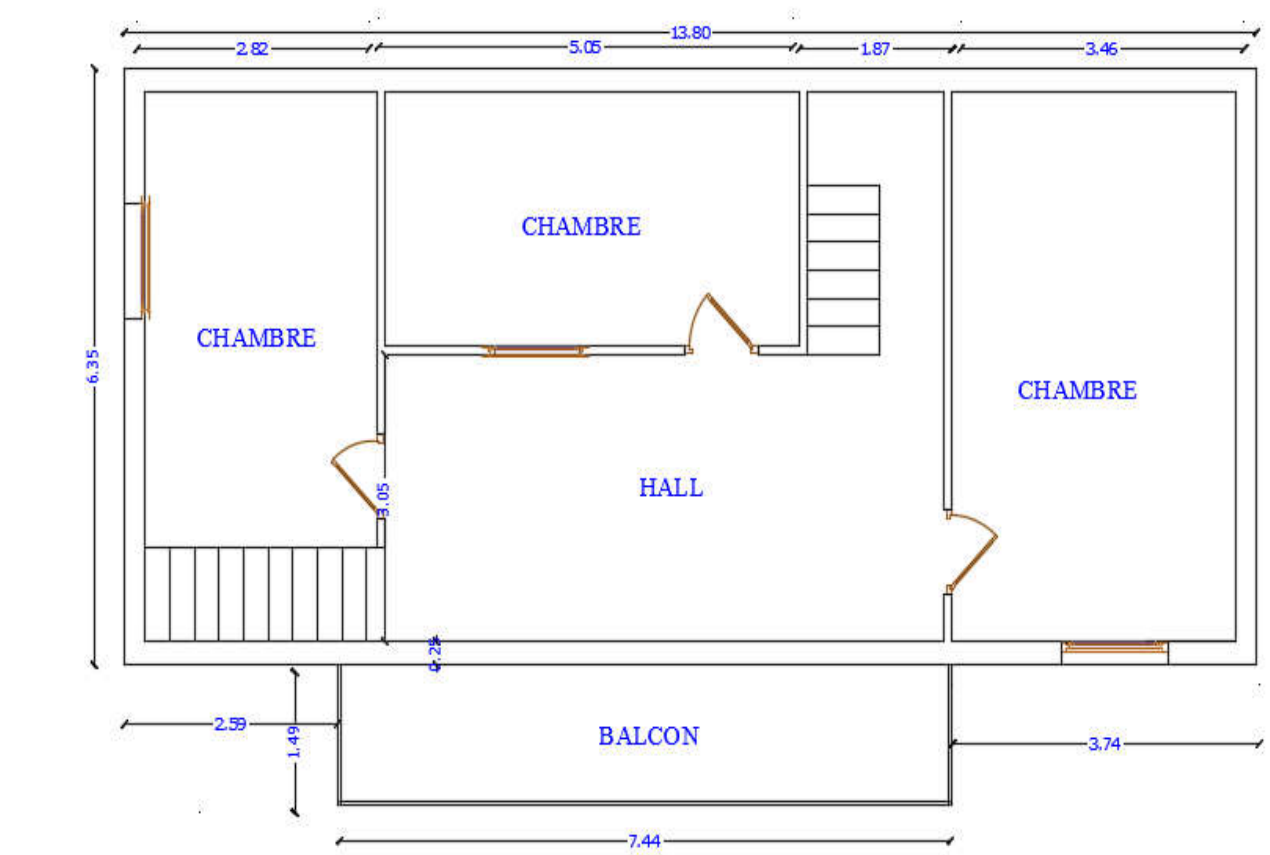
Plan de 1^{er} étage construit avec parpaing en 1964.
